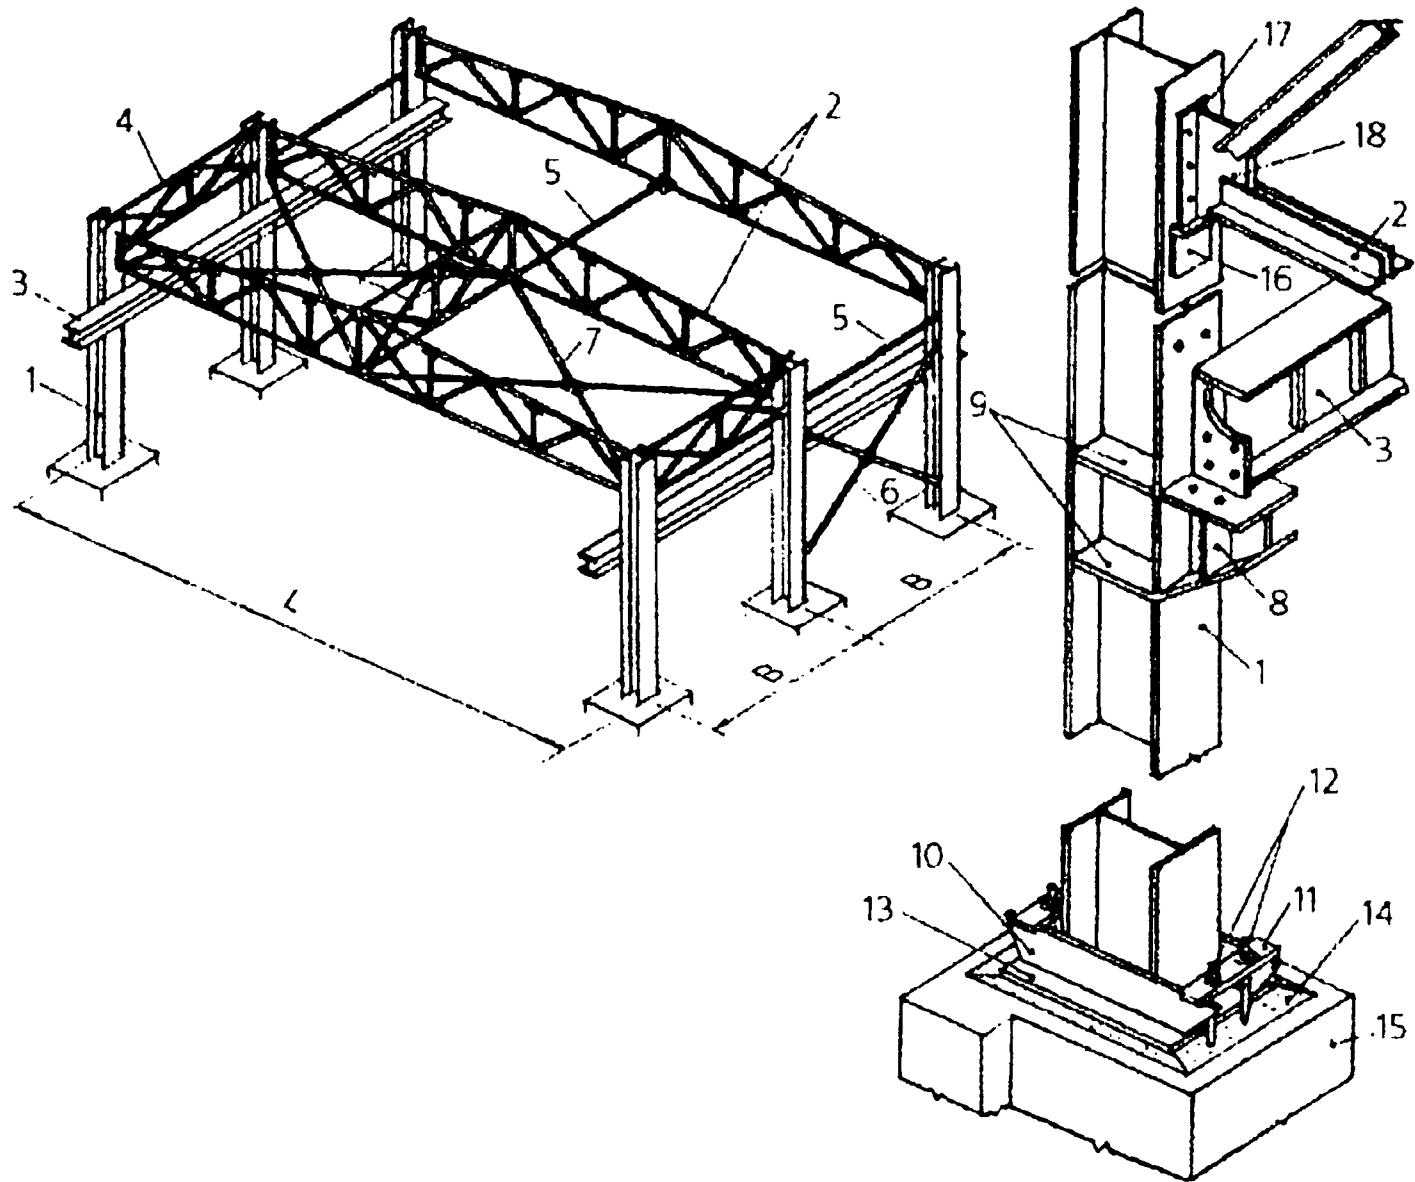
Одноэтажный металлический каркас промышленного здания. Элементы: 1 - колонны; 2 - стропильная ферма; 3 - подкрановая балка; 4 - вертикальные связевые фермы; 5 - растяжка в уровне нижнего пояса ферм; 6 - вертикальные крестовые связи между колоннами; 7 - горизонтальные крестовые связи в уровне нижнего пояса ферм; 8 - подкрановая консоль; 9 - ребра жесткости; 10 - траверса; 11 - анкерная плитка; 12 - анкерные болты; 13 - опорная плита; 14 - цементный раствор; 15 - бетонный фундамент; 16 - опорный столик; 17 - опорная планка; 18 - фасонка
